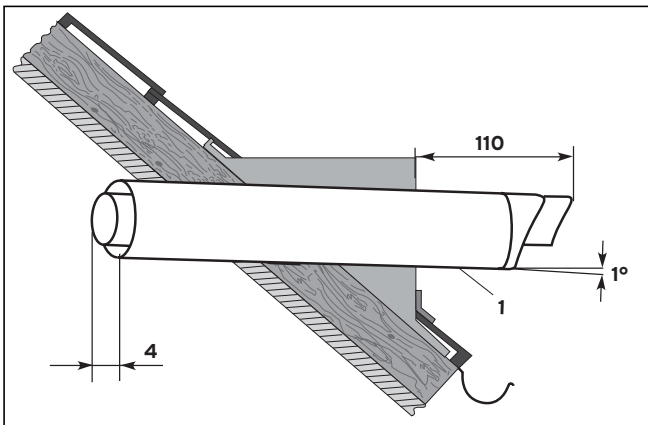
Вмонтаживание горизонтального кровельного ввода
